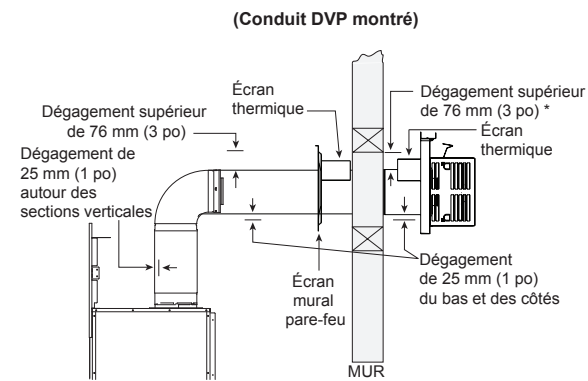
Dégagements entre les conduits horizontaux et les matériaux inflammables Matériaux
